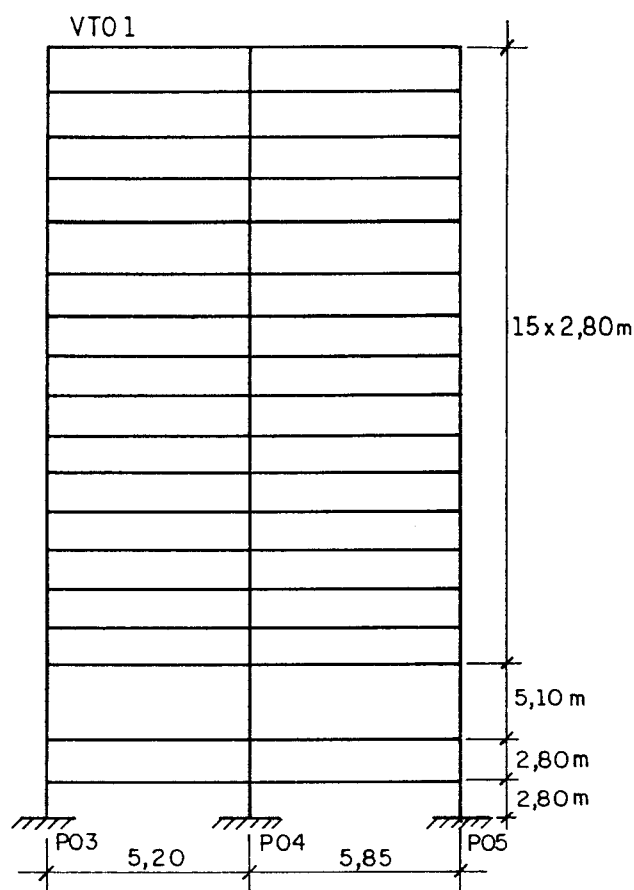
Pórtico plano com a viga VT01 a partir do 4.^o pavimento
